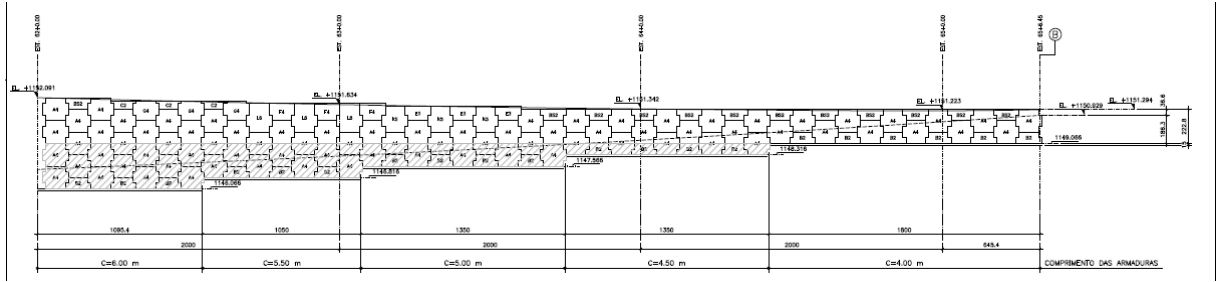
Elevação Solo Reforçado Eixos AB-2
